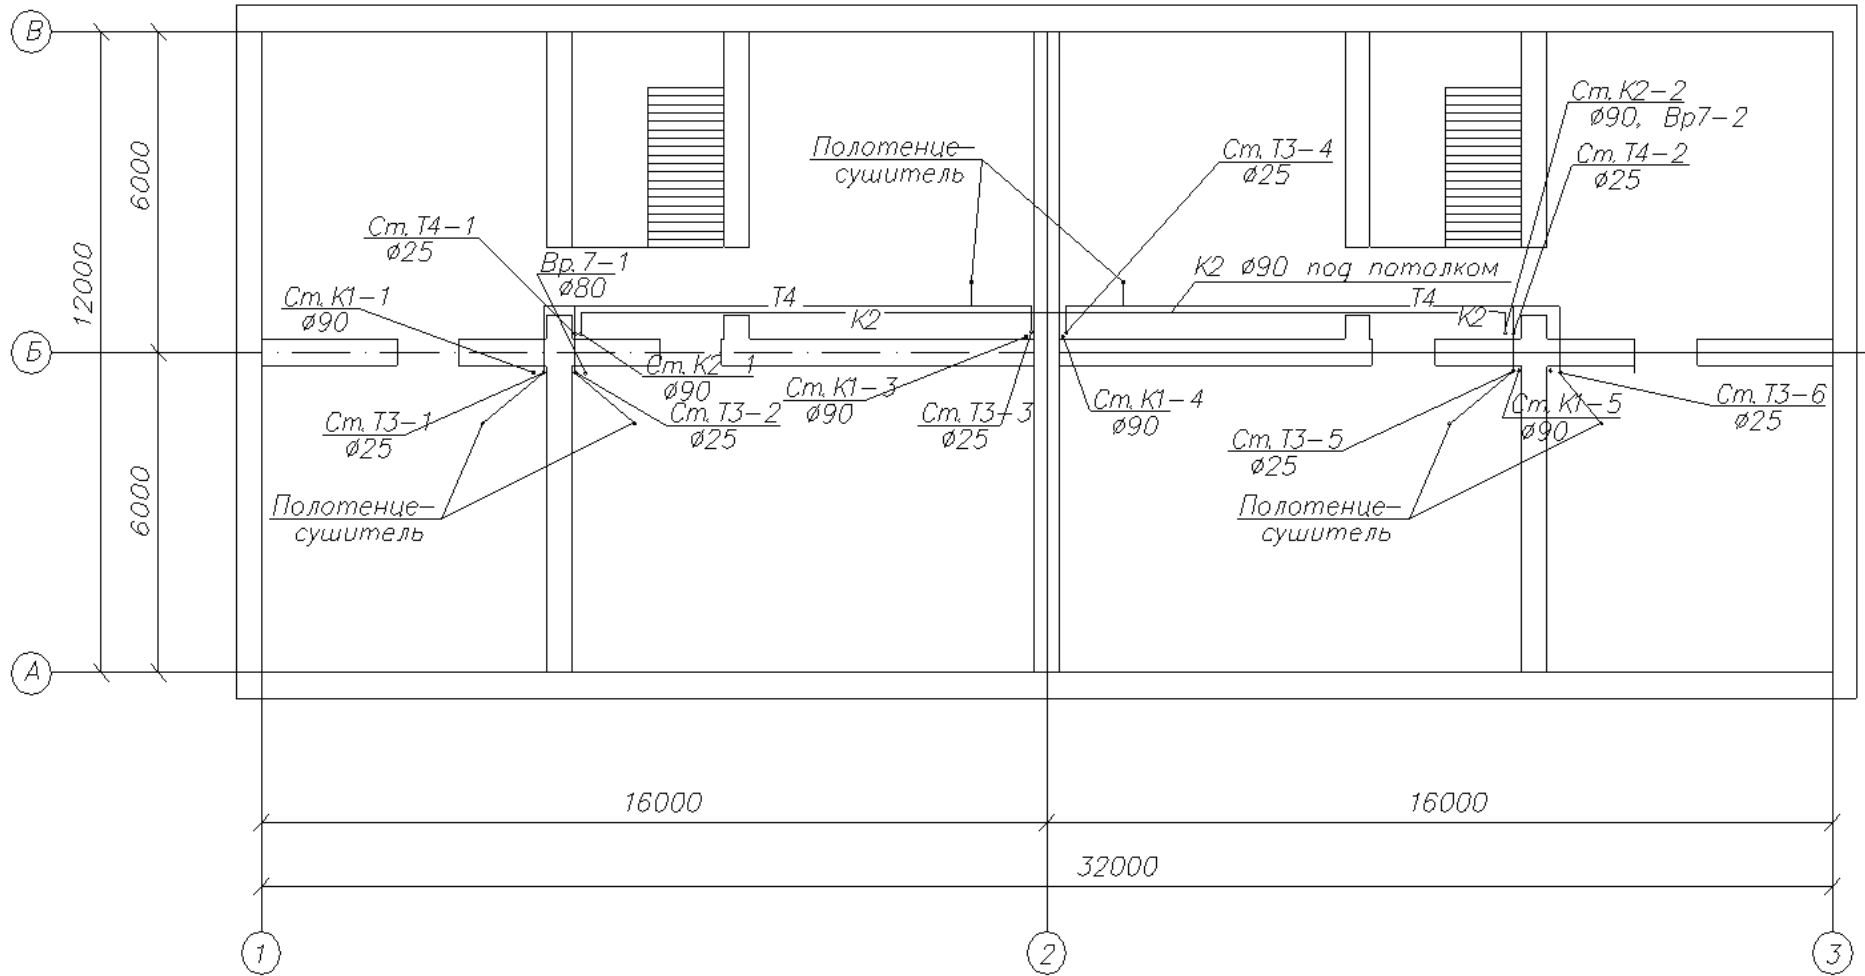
Трассировка трубопроводов на планах здания: технический этаж
